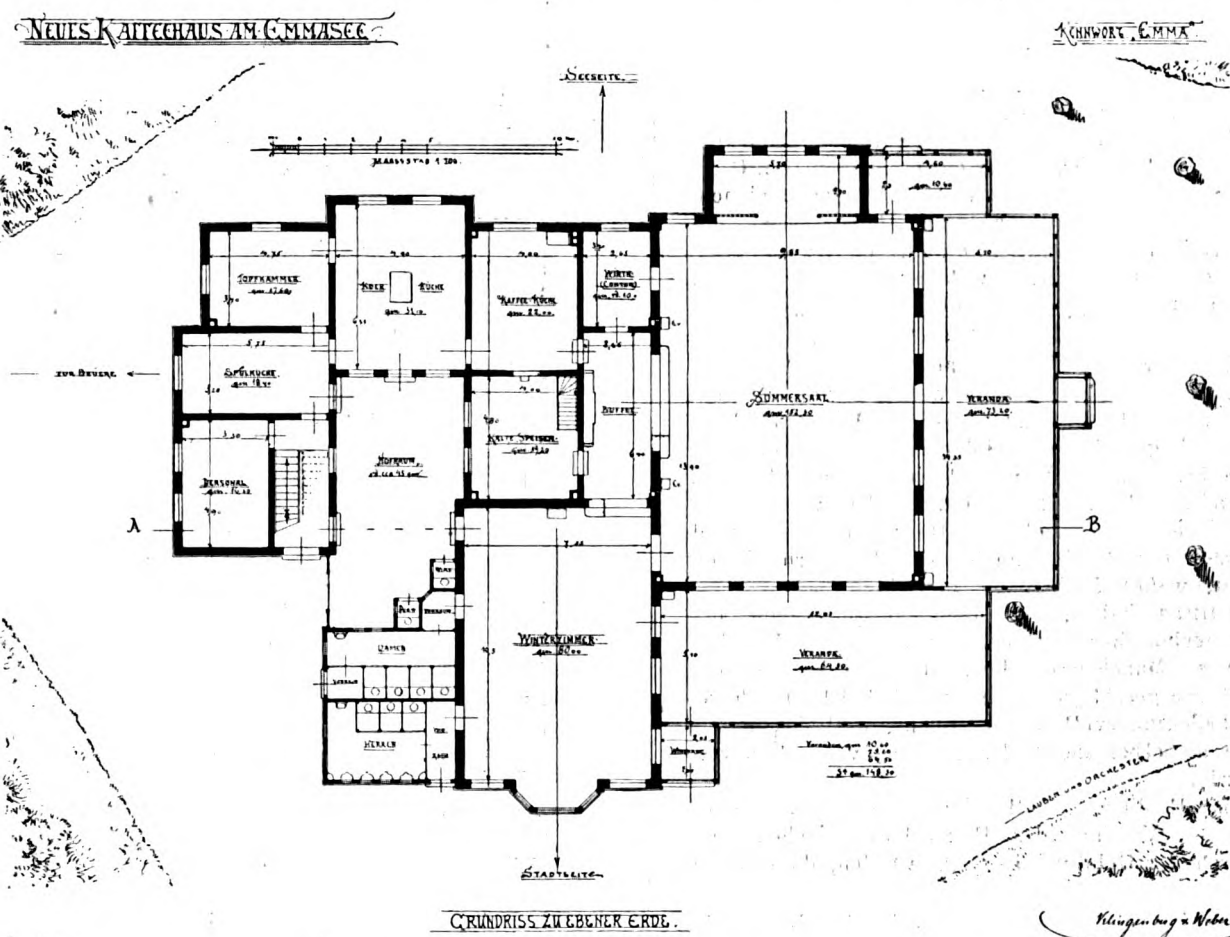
Neues Kaffeehaus am Emmasee zu Bremen. Grundriss.
